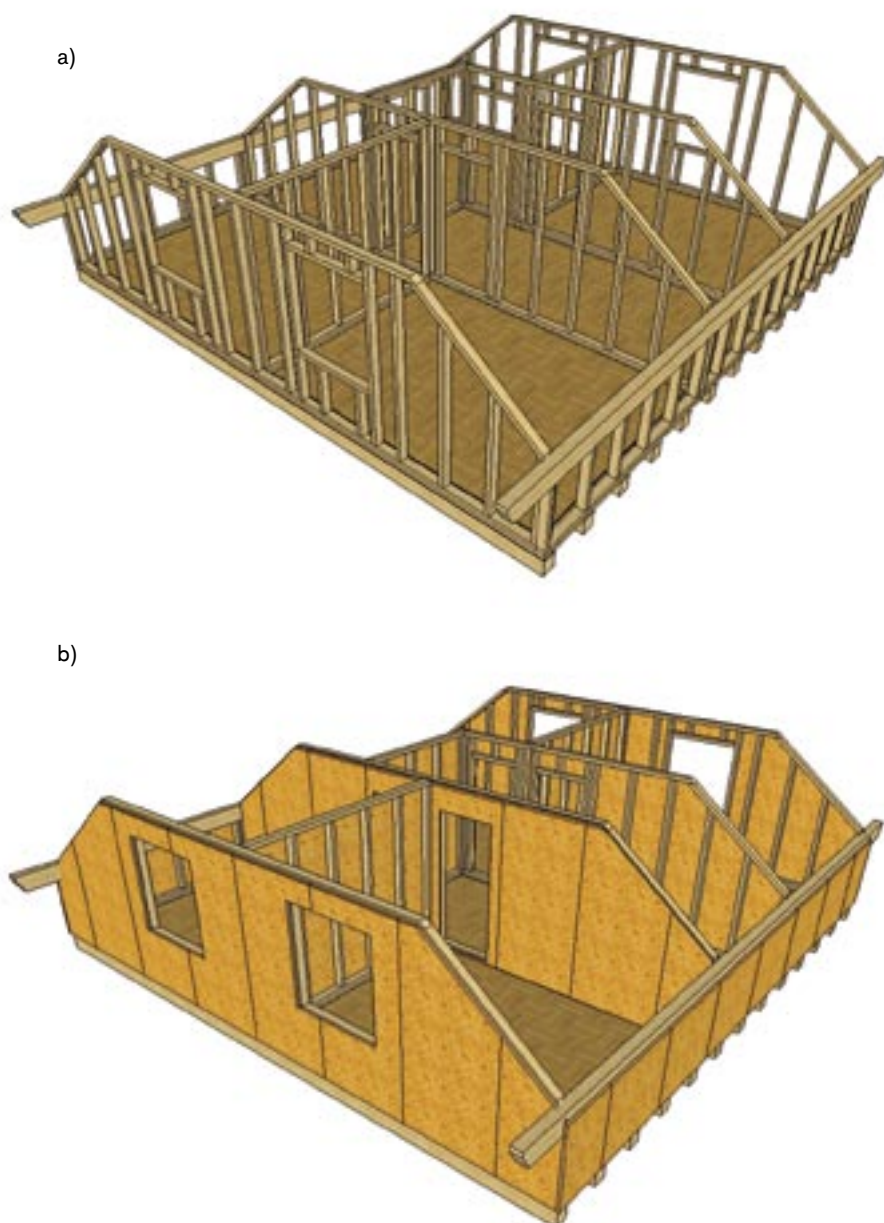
Skladba sloupkové konstrukce stěny pro pasivní domy
